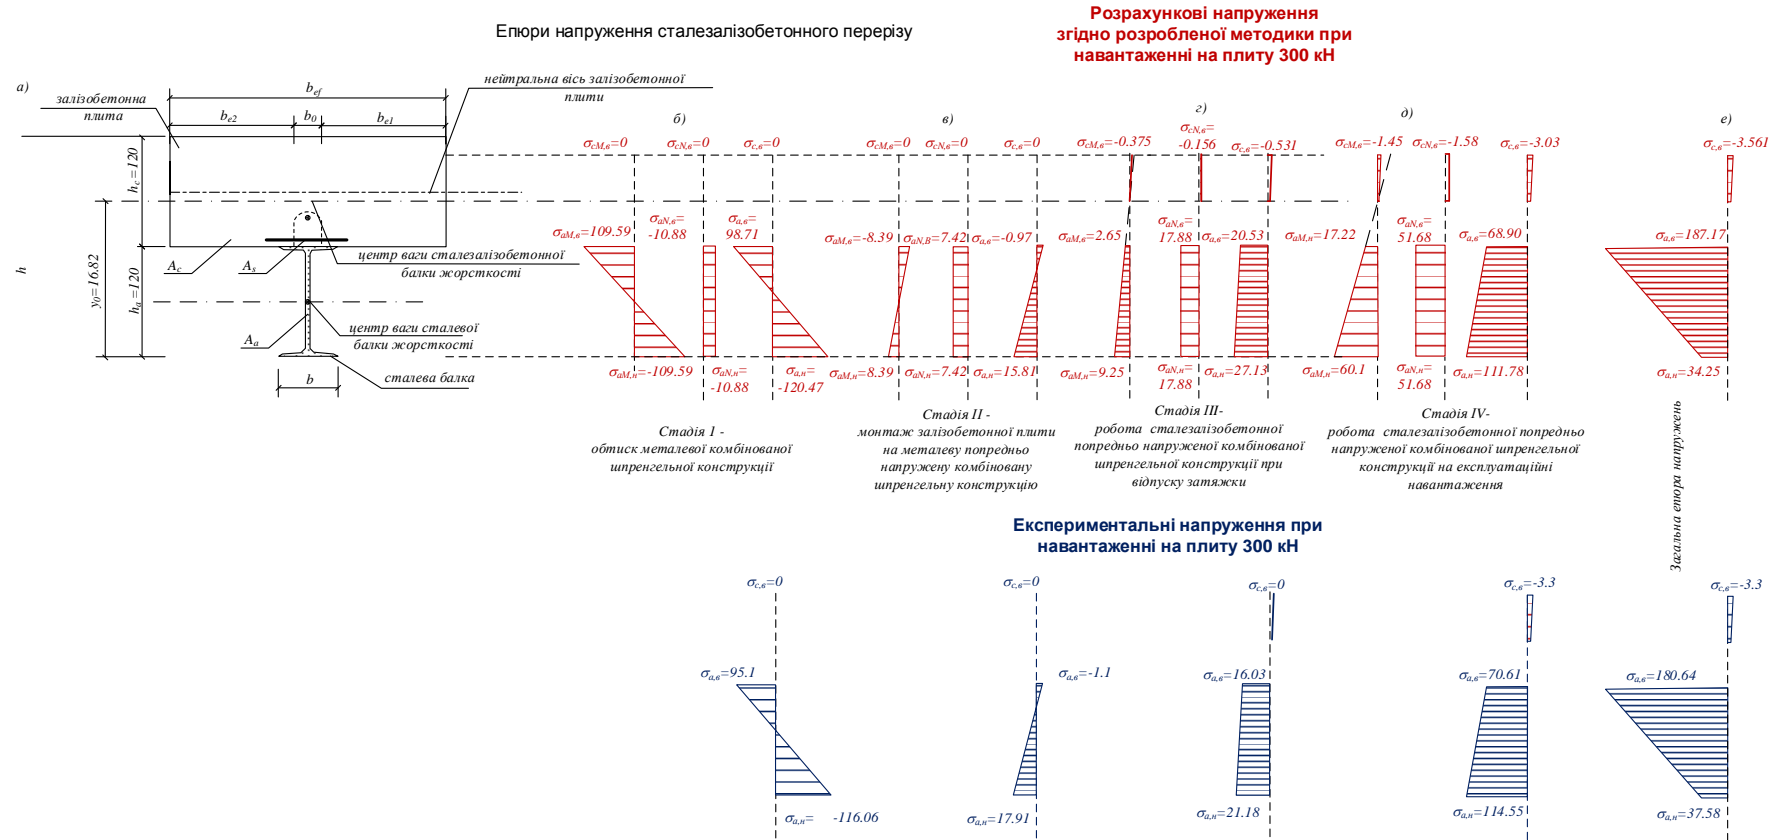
Епюри напружень при різних стадіях навантаження балки жорсткості: а) розрахункова схема сталезалізобетонного перерізу; б) стадія I – обтиск металевої комбінованої шпренгельної конструкції; в) стадія II – монтаж залізобетонної плити на металеву ПНШК; г) стадія III – відпуск напруженої затяжки в сталезалізобетонній ПНШК; д) стадія IV – робота сталезалізобетонної ПНШК на дію експлуатаційних навантажень; е) сумарна епюра напружень.
